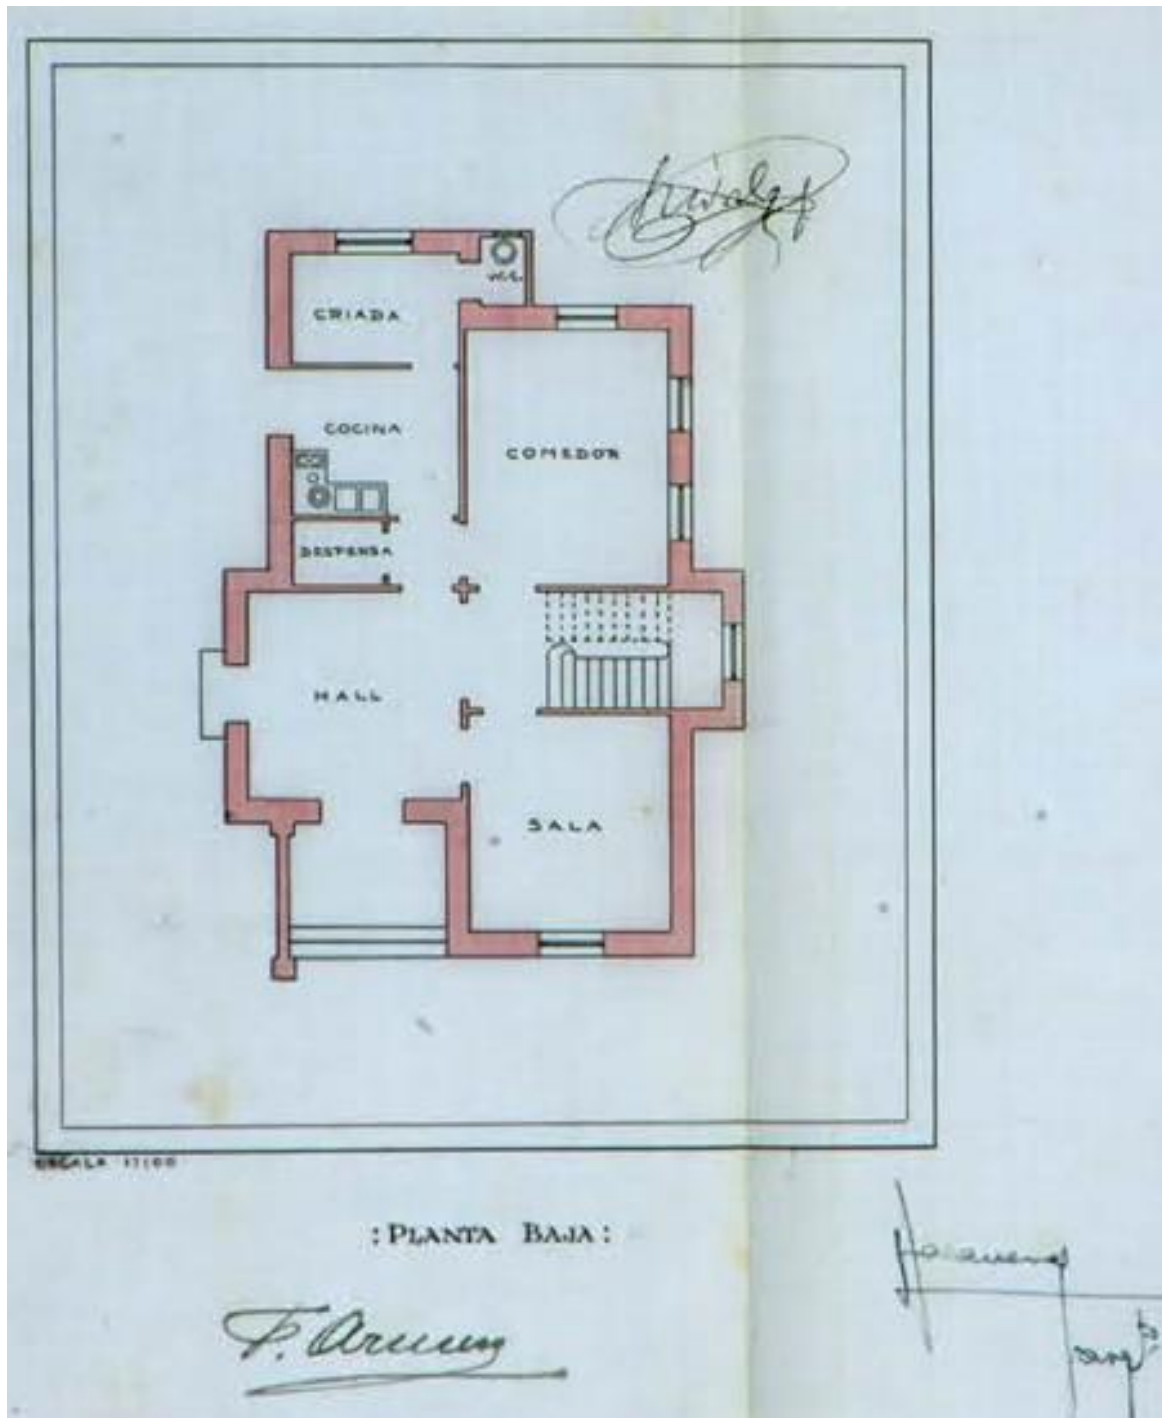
Plano original de planta baja (Fuente: Gerencia de Urbanismo)
